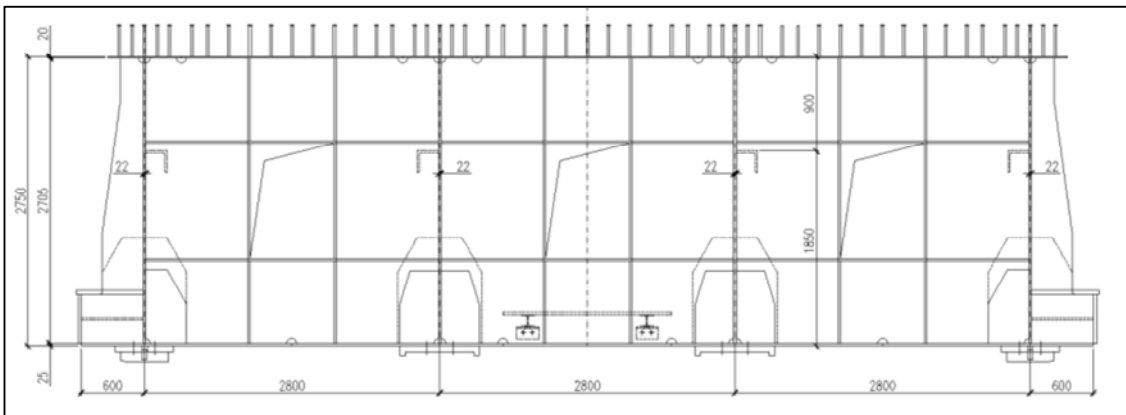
Progetto Esecutivo - Sezione in appoggio
